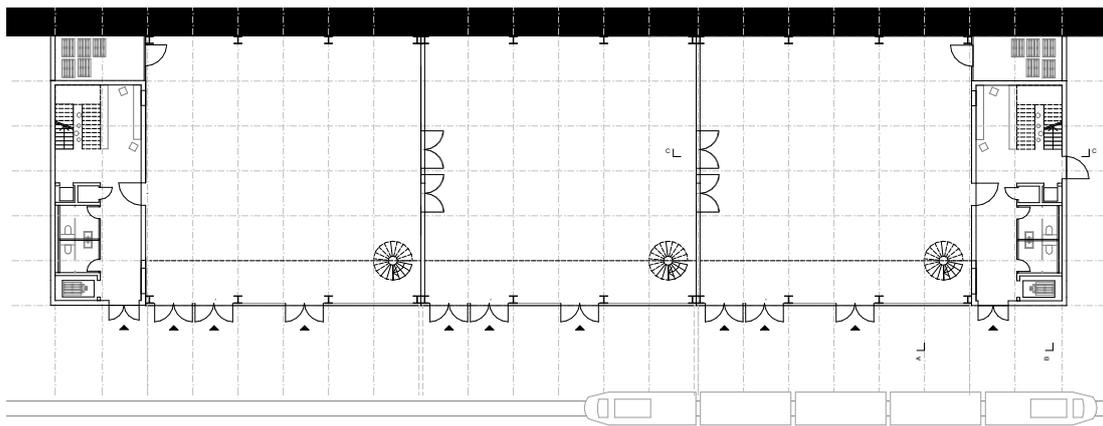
Grundriss Untergeschoss zusammengesetzte Bausteine, M 1:500
